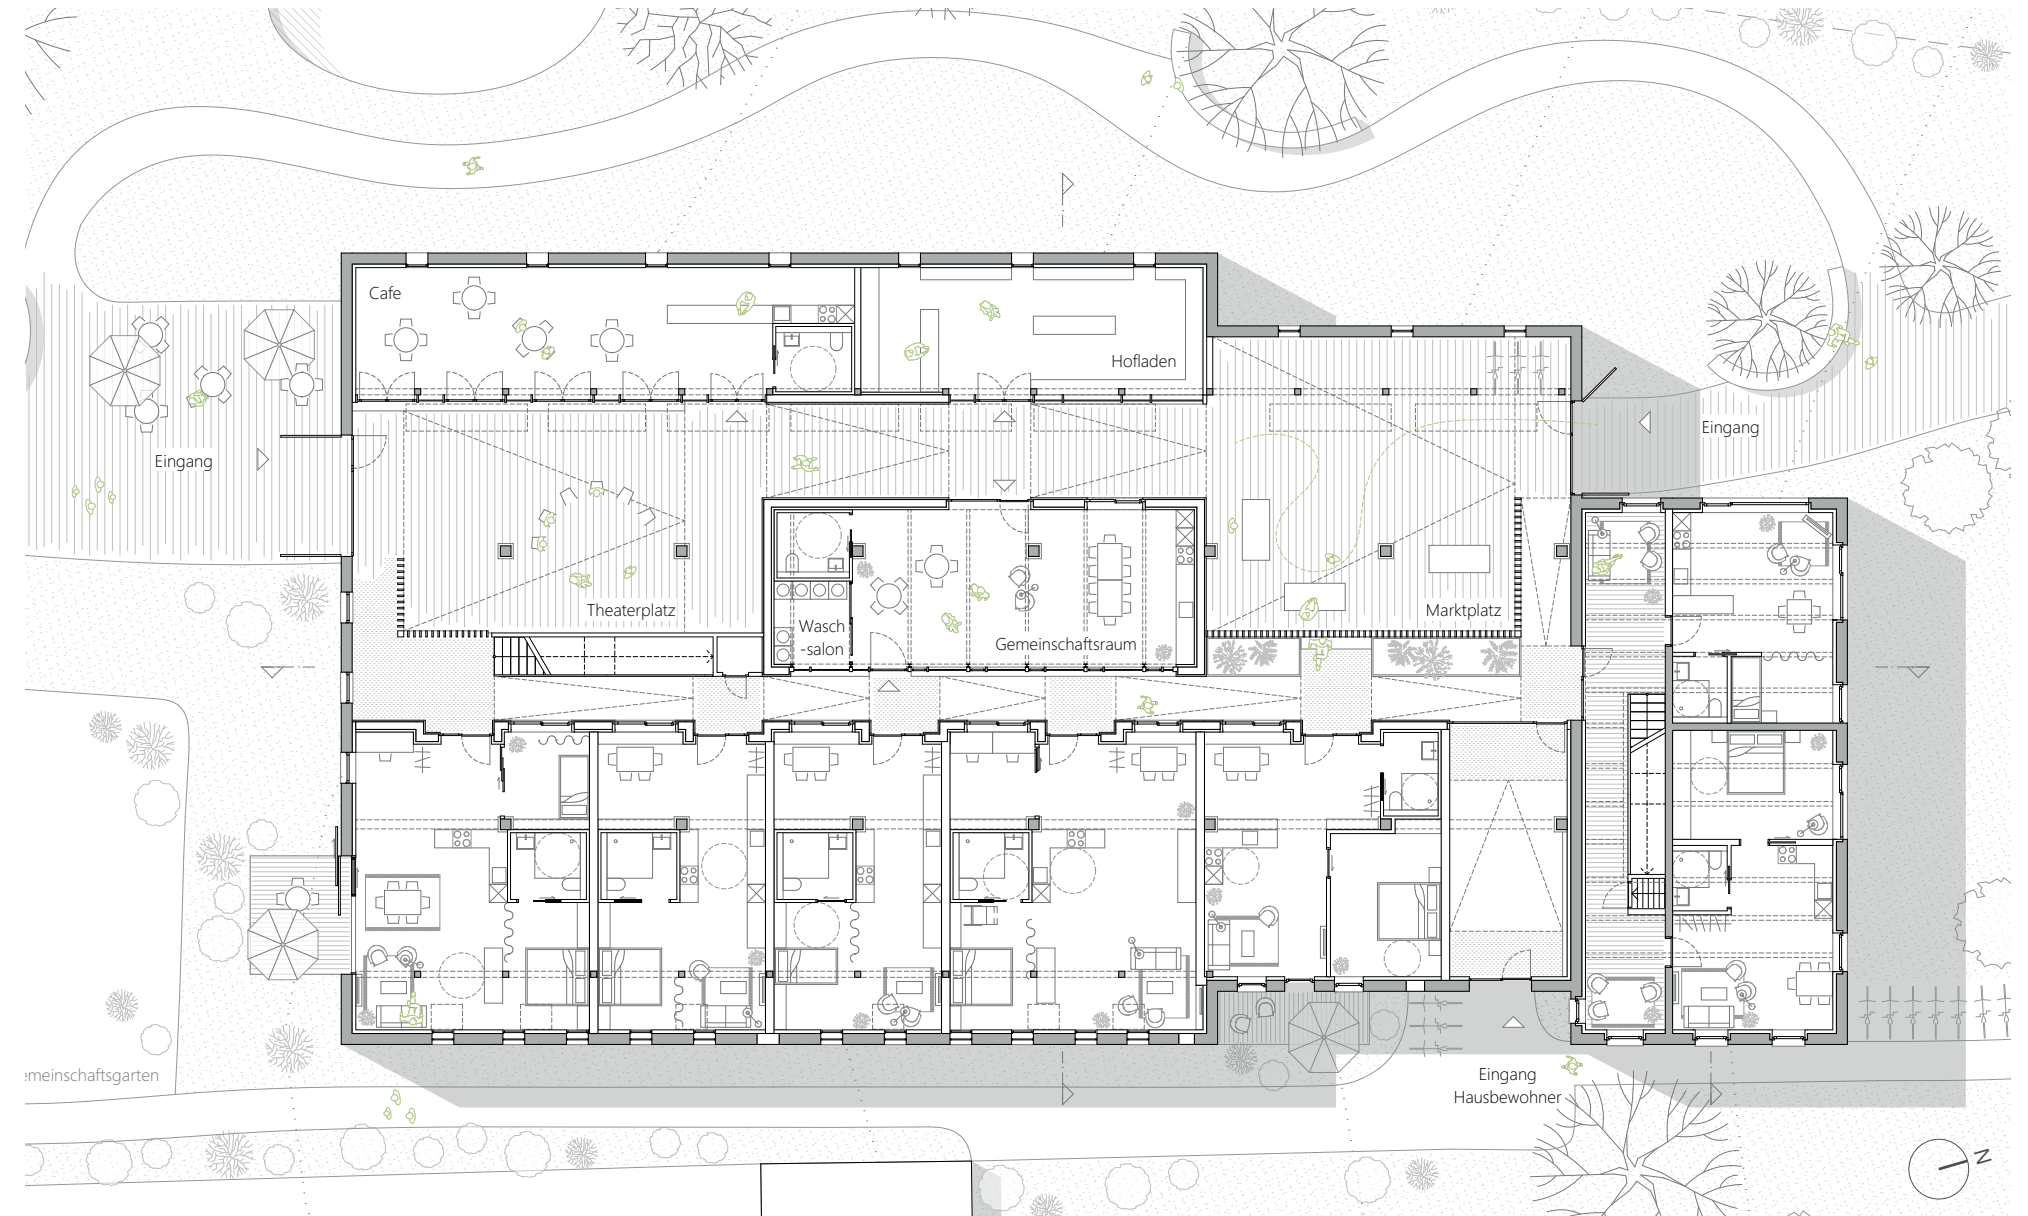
Grundriss Erdgeschoss mit Umgriff M 1.500
